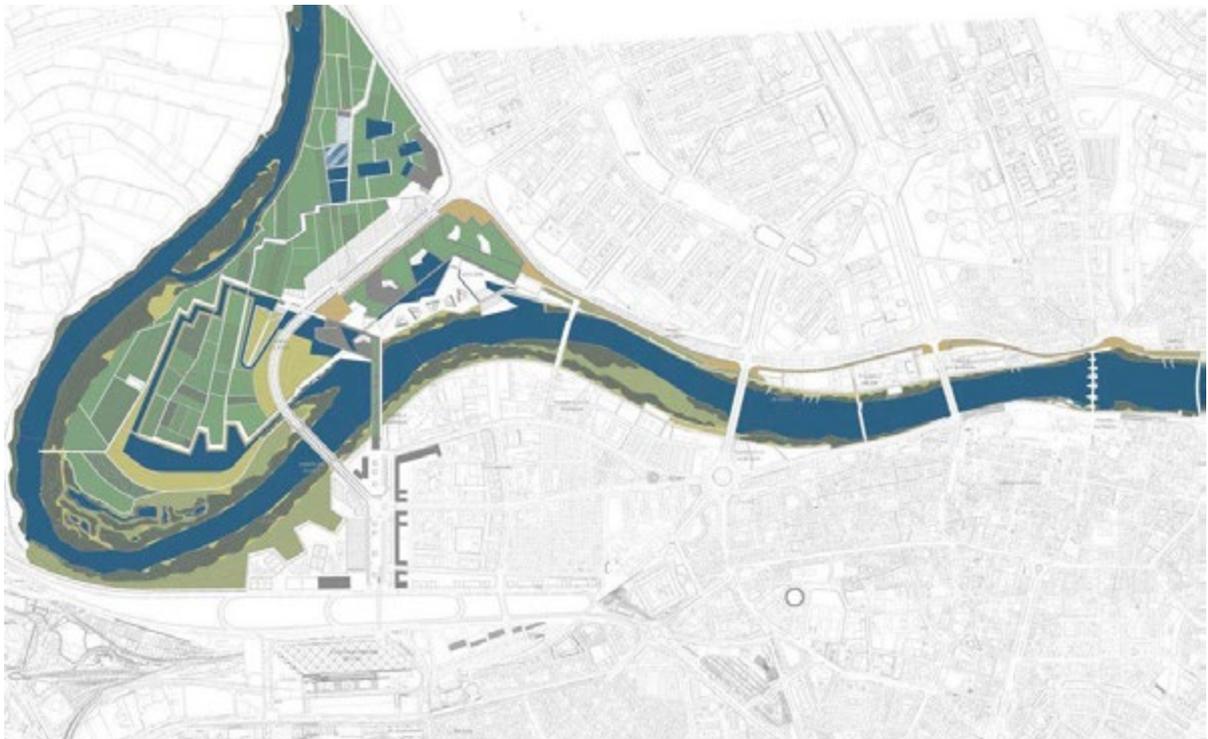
Planimetria generale di progetto del Parco delle Acque, Saragozza. © Alday Jovier, Christine Dalnoky,2008.
